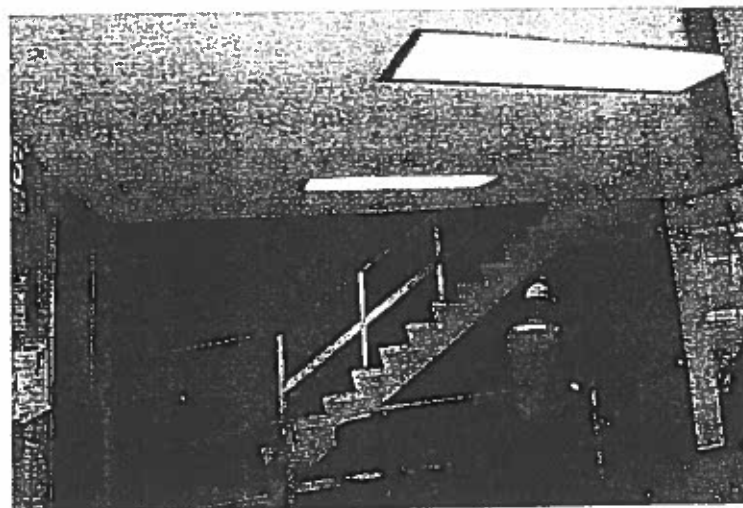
Extracción de testigo D5, en Placa del descanso de Escalera 2, en 2do piso.
